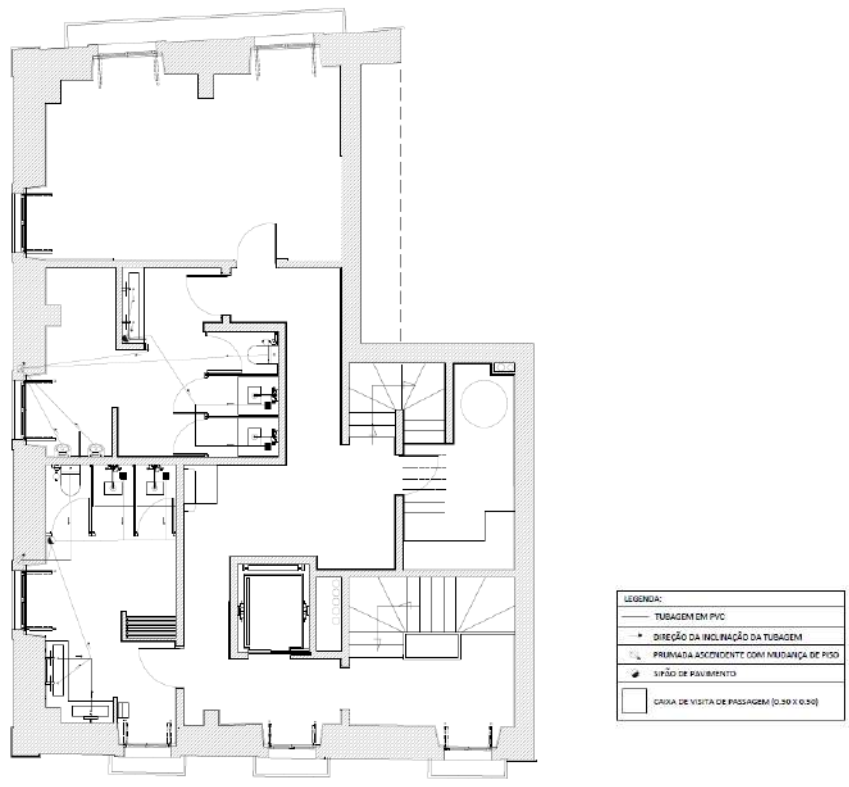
Planta de Sistema de Drenagem Predial de Águas Residuais - Piso 2
